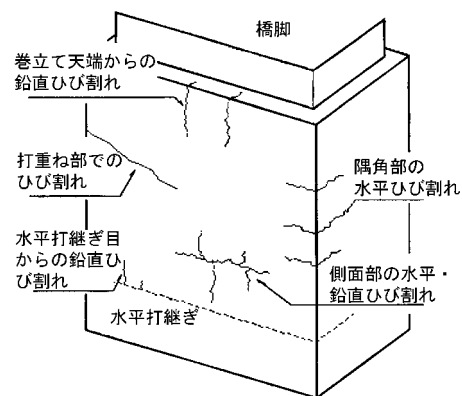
橋脚の巻立てコンクリートに発生するひび割れパターン<sup>3)</sup>
